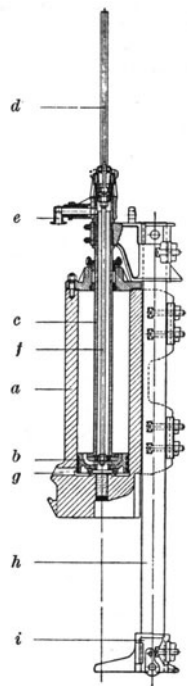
Schnitt durch einen Dampfären. (Nach Hetzel-Wundram: Die Grundbautechnik S. 356.)
